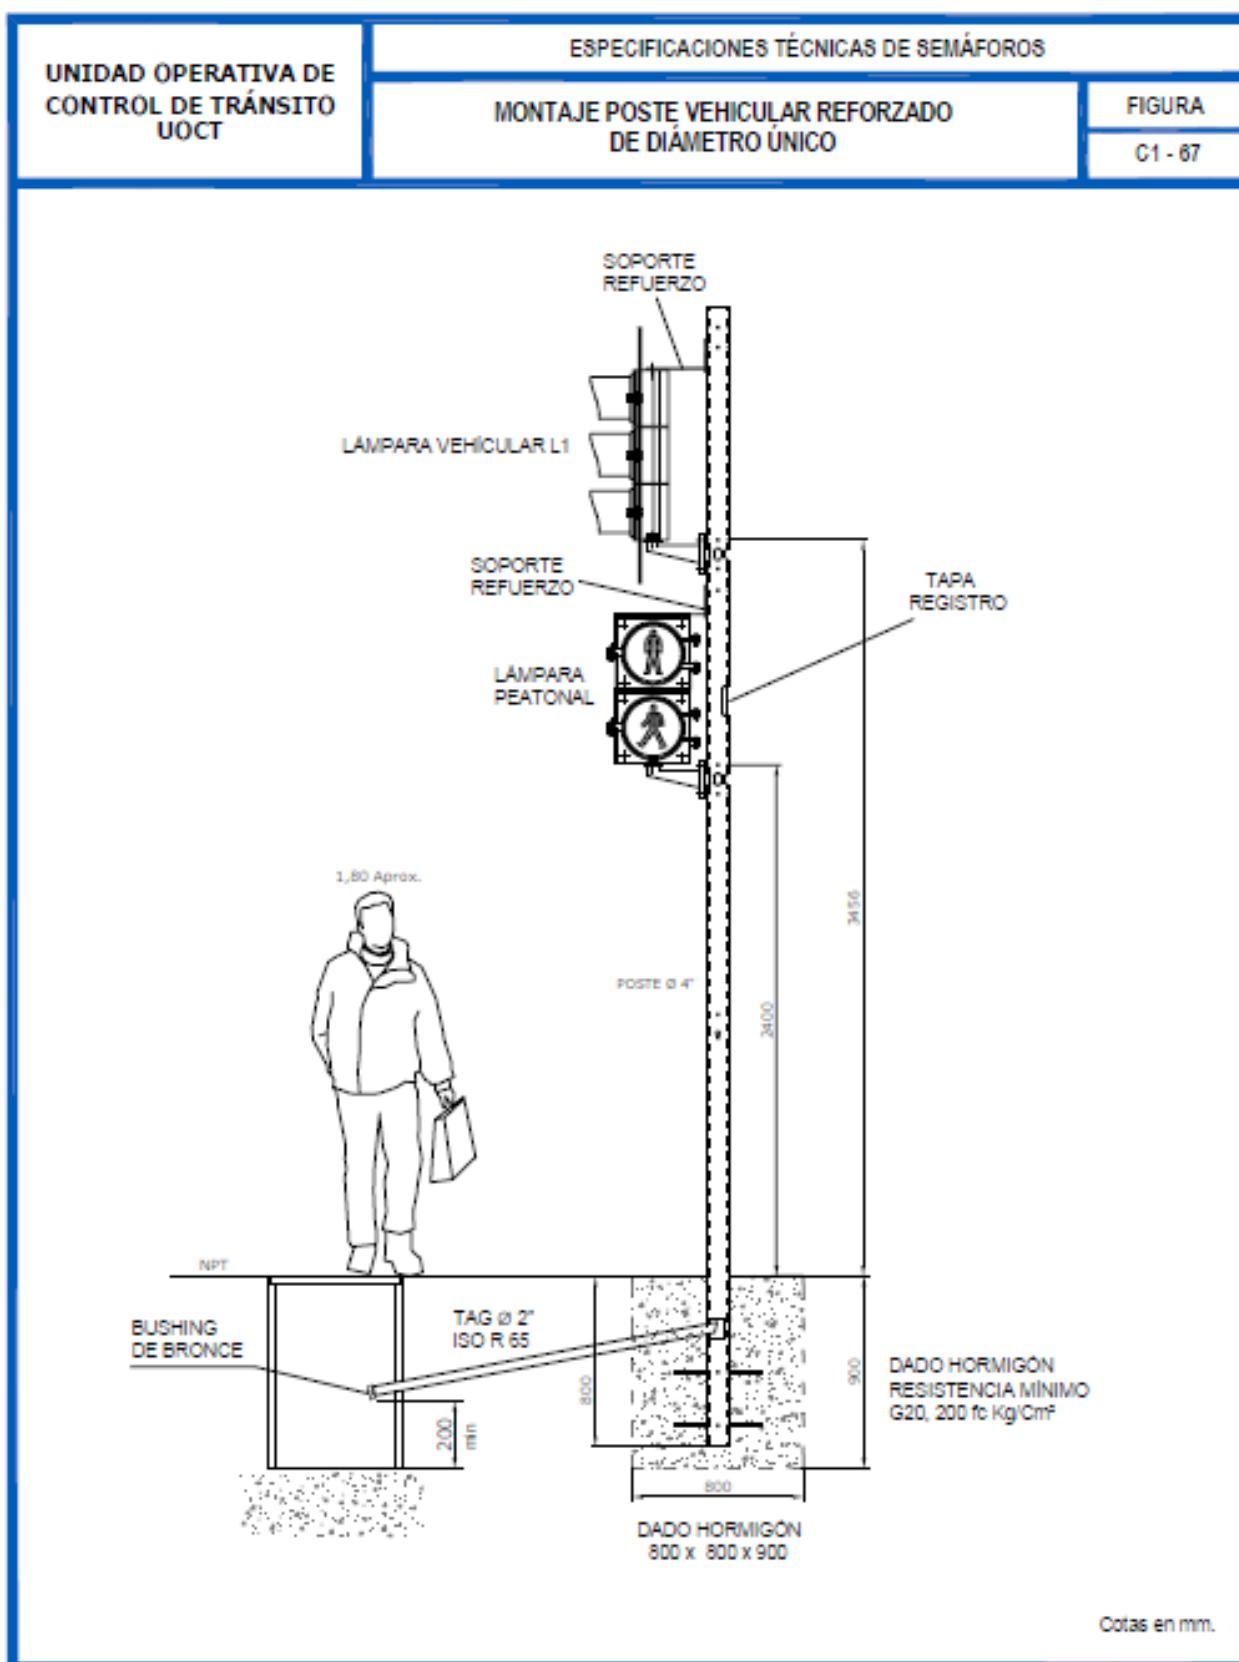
67 Montaje Poste Vehicular Reforzado de Diámetro Único
